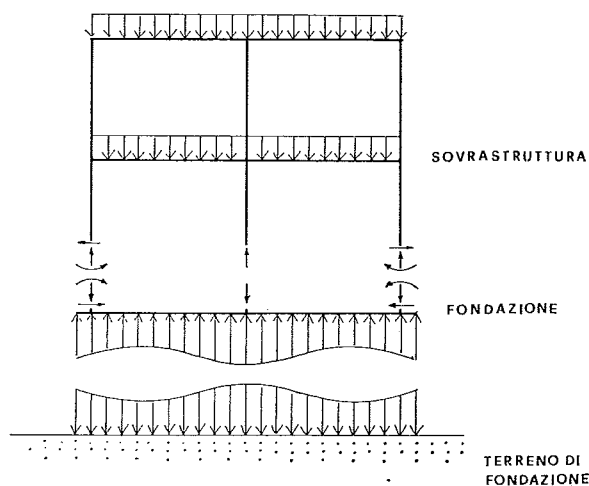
Schema del complesso sovrastruttura-fondazione-terreno e relative azioni mutue.
